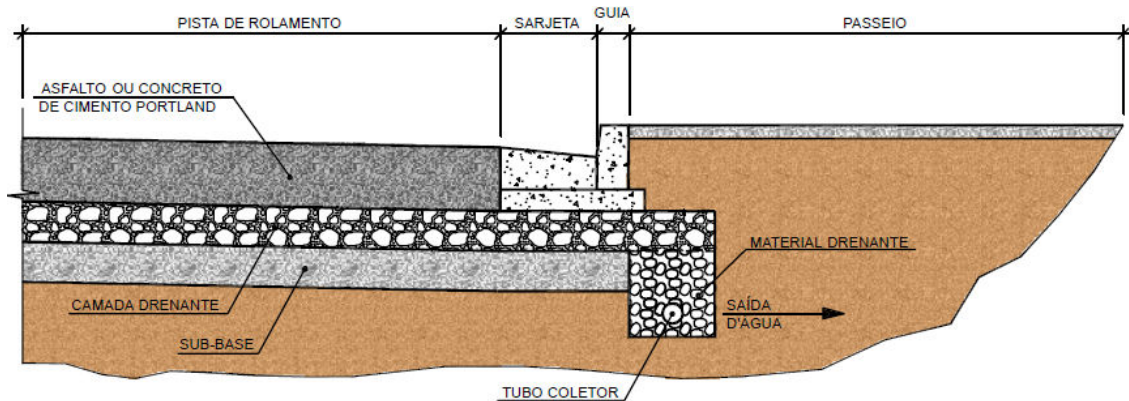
Ilustração da seção de pavimento mostrando posicionamento da camada de drenagem em pavimento com passeio e sem acostamento.
